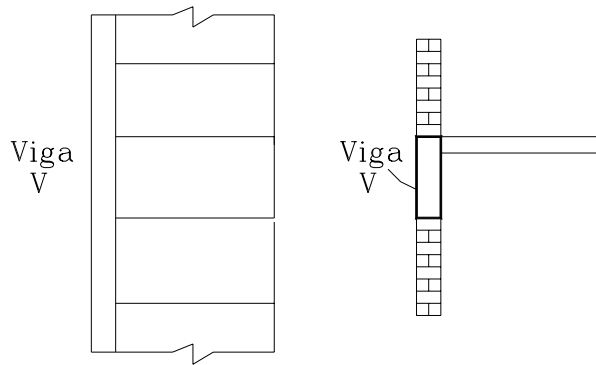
Laje em balanço, engastada em viga lateral (MANCINI, 1971)
